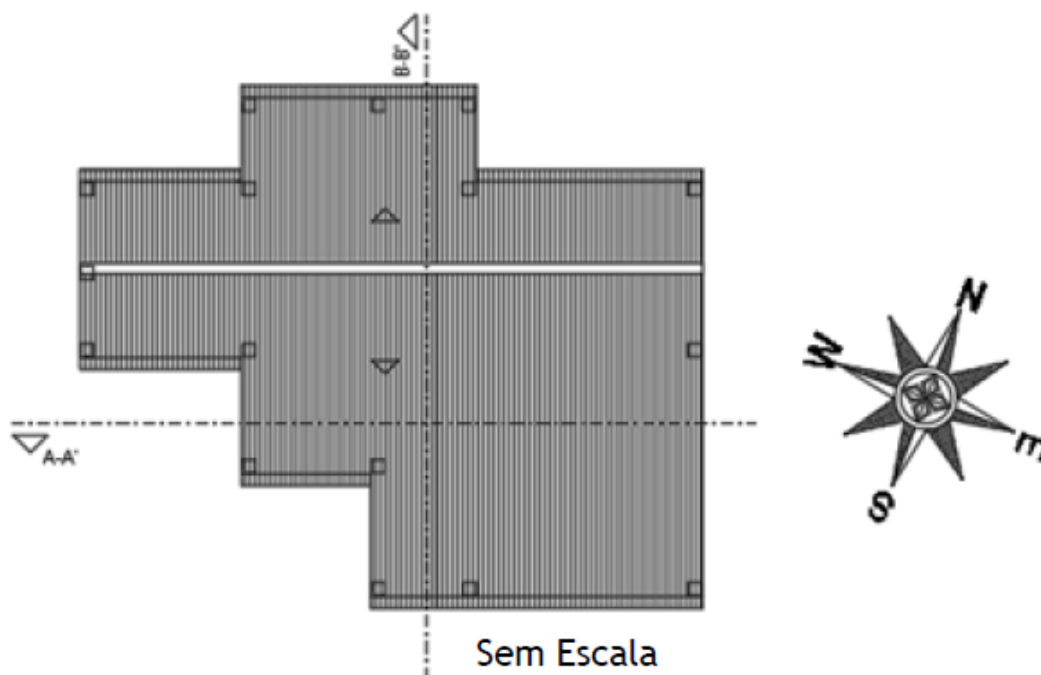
Planta da cobertura da habitação em estudo (Caso de Estudo 1)
